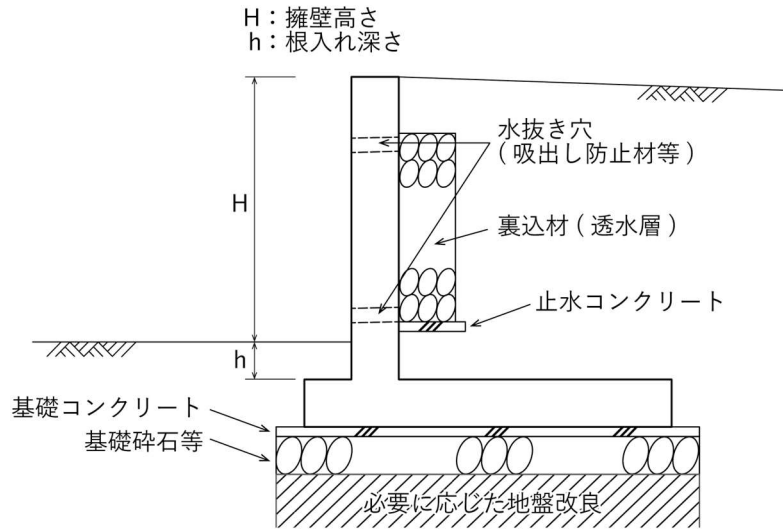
鉄筋コンクリート造擁壁の標準断面図
